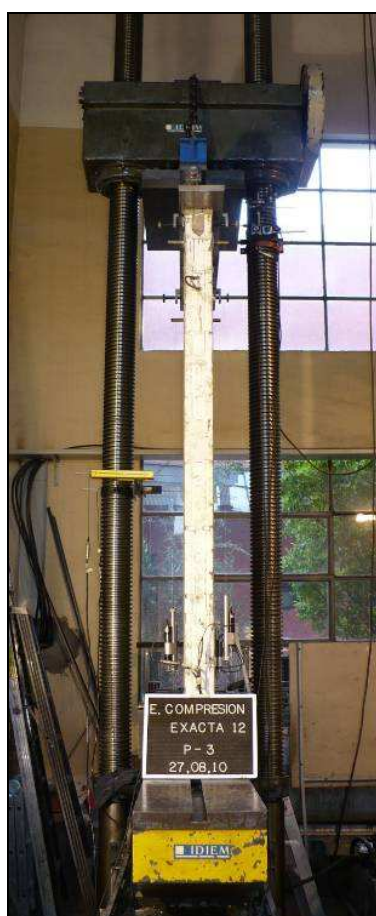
Vista general del montaje del ensayo de compresión excéntrica al muro.
